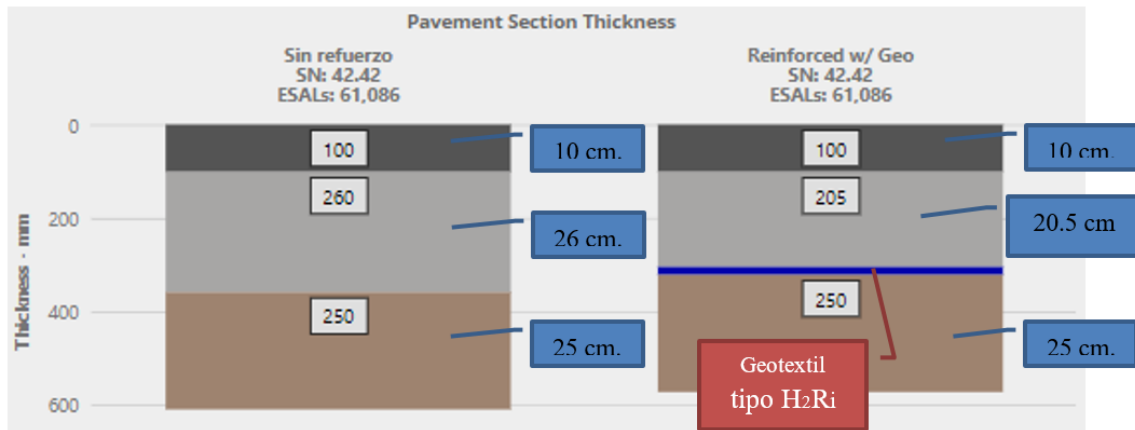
Resultados de los espesores del pavimento flexible reforzado con geotextil tipo H2Ri.
